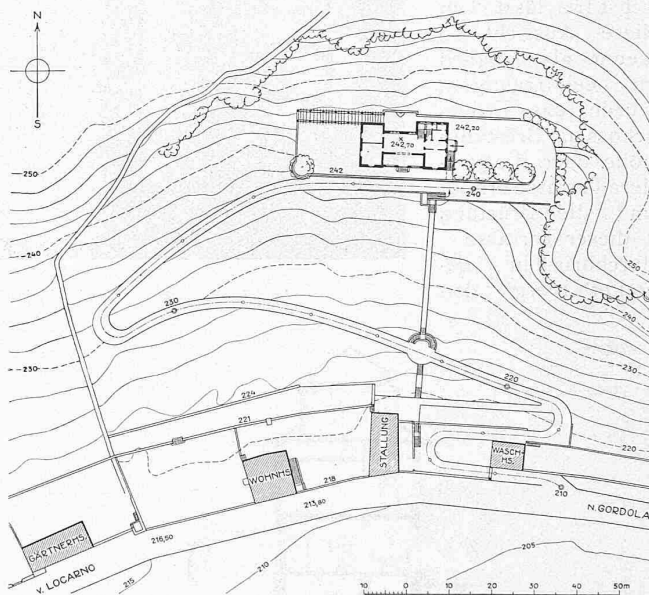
Landhaus Verbanella bei Locarno, Lageplan 1:1600.
